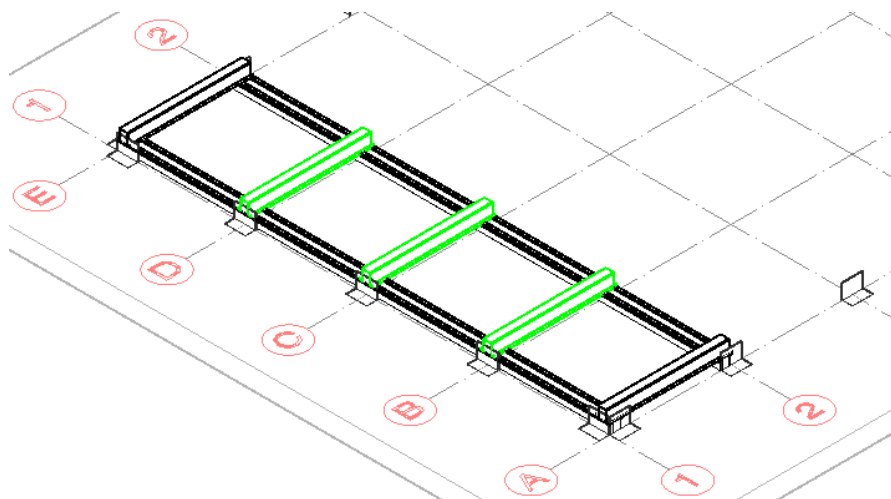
Isometría de Panel de 610mm x 2.460mm Colocado en Piso
